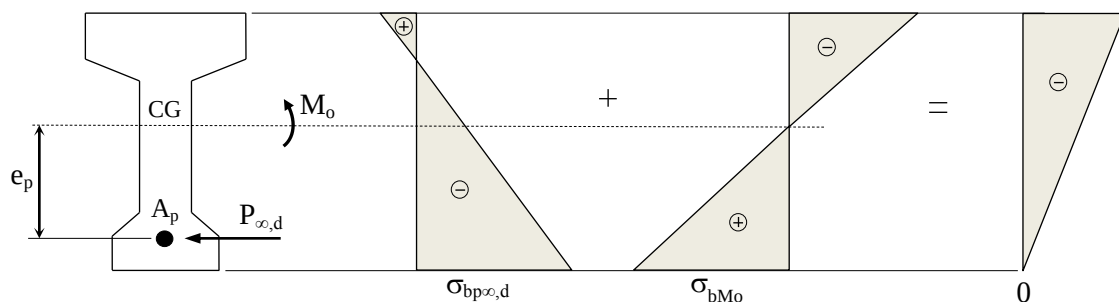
Tensões normais na viga e estado de descompressão.
